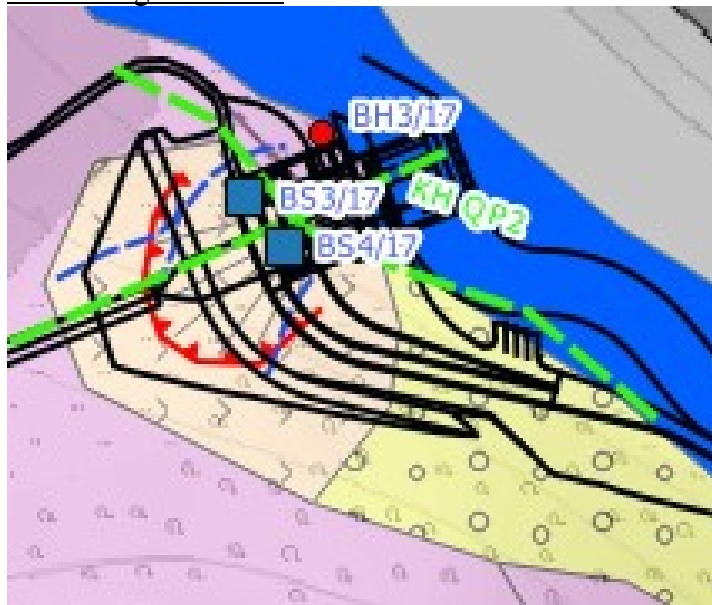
Lageplan Krafthaus - KW Schneizlreuth (nicht masstäblich)
